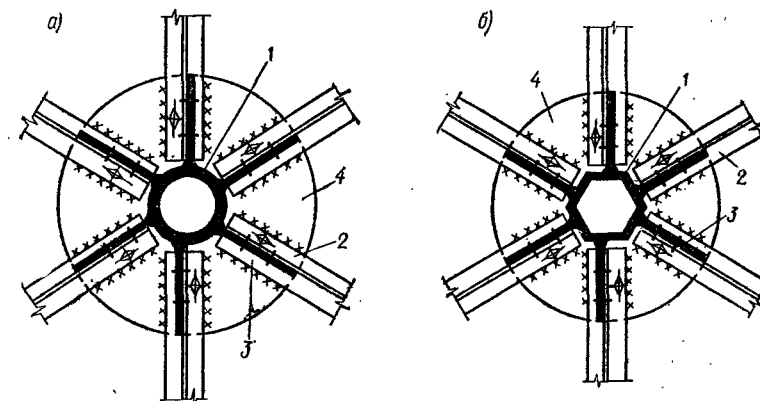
Узлы соединения балок с колоннами при треугольной сетке колонн
